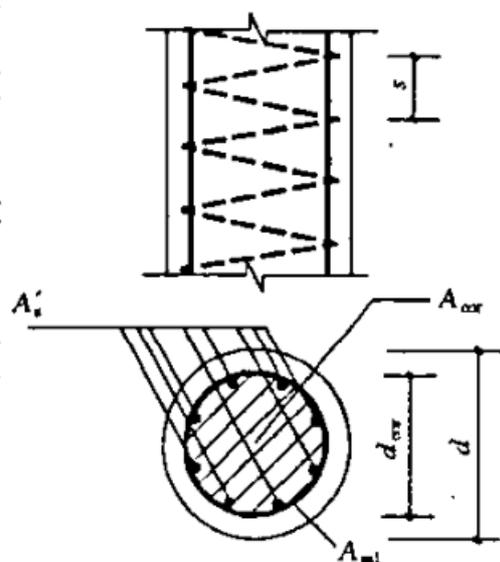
配置螺旋式间接钢筋的钢筋混凝土轴心受压构件
